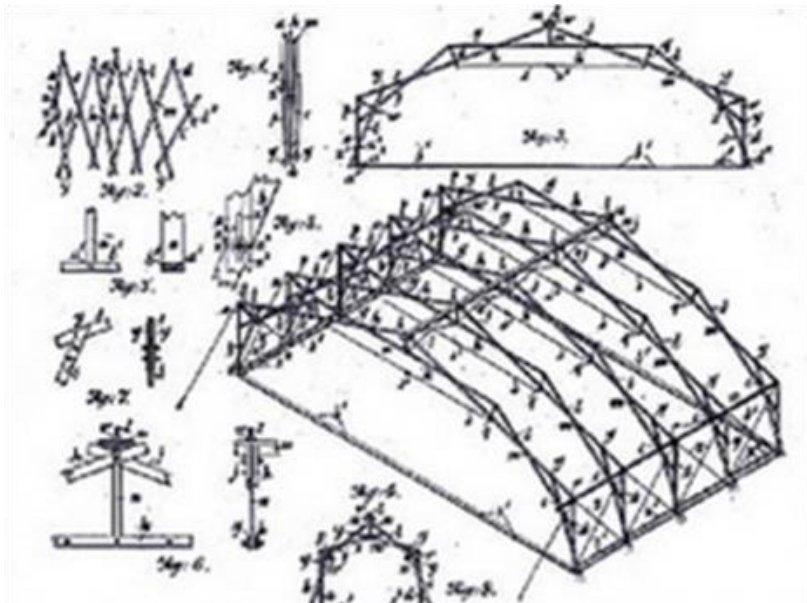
Patente Barde Salden Watkins. Estructura desplegable para tiendas, puentes temporales o estructuras portables [13].
